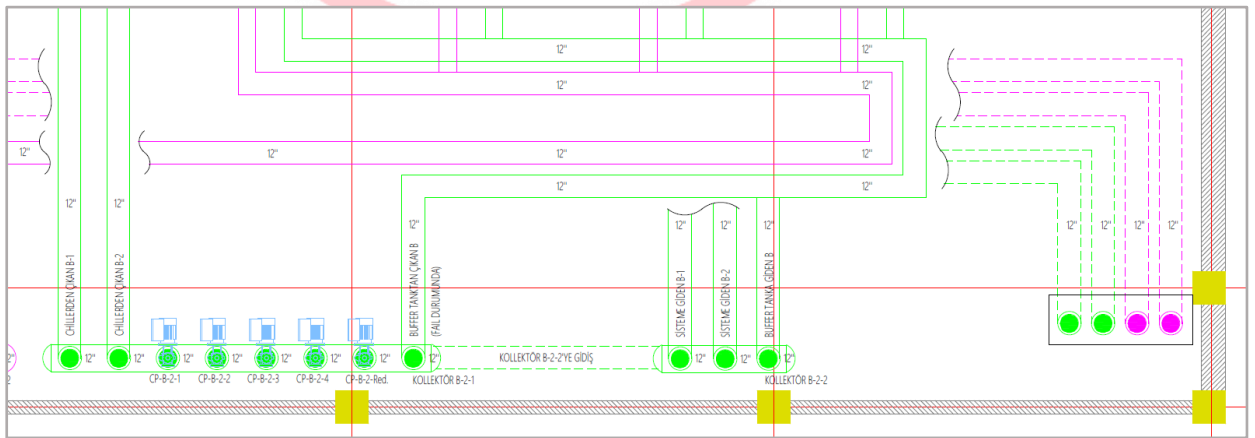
Daldırmayla Sıvı Soğutmalı Veri Merkezinin Çatı Planı Tasarımı Detay-3
